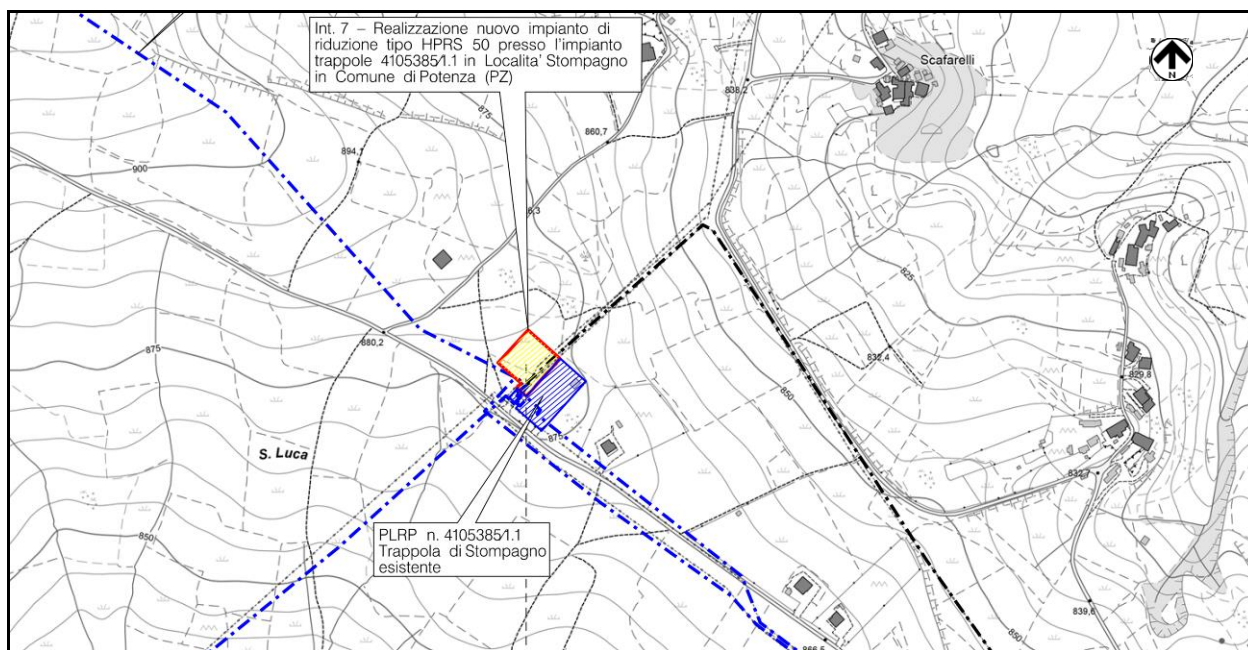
G.b – Planimetria 1:5.000 con localizzazione dell'area dell'Intervento n.7 (progetto in rosso, dismissione in verde, esistente in blu)
